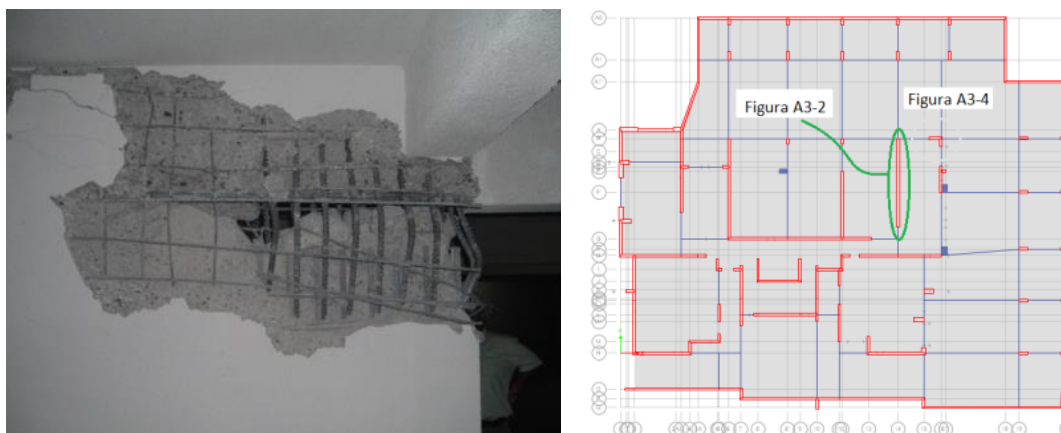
Imagen del daño y ubicación en planta del elemento A3-2
